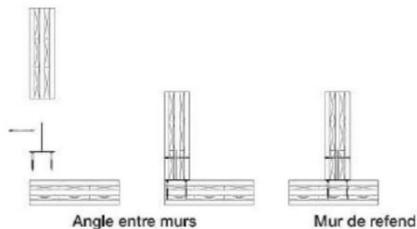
Assemblage bois-métal entre murs par plaques métalliques en âmes
